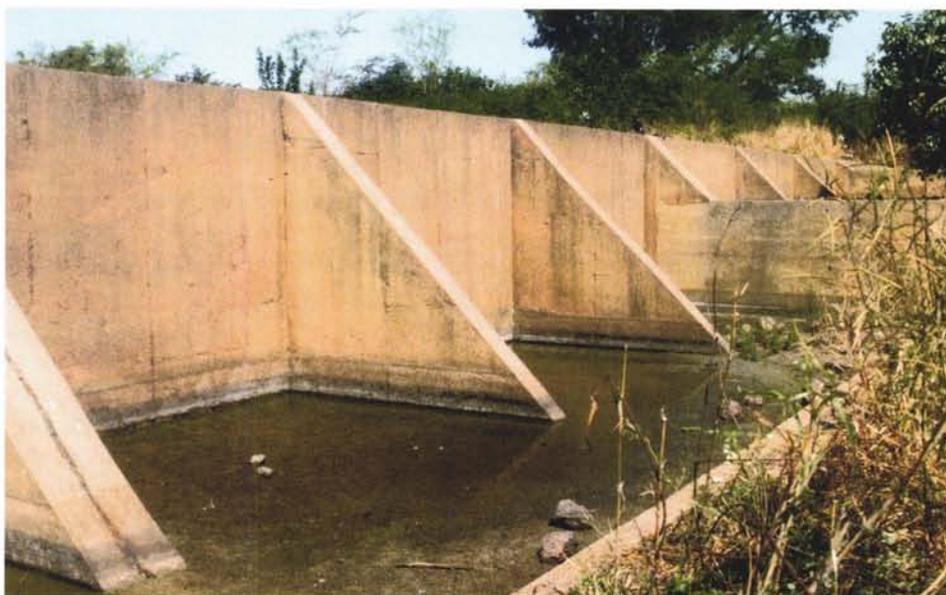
D-2 : Vue en détail de l'extrémité rive gauche ; remarquer au premier plan le joint en mastic bitumineux placé entre deux plots.
